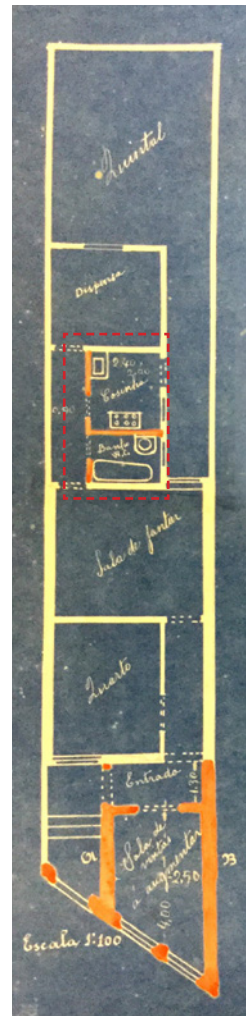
e 3.25 Plantas com banheiros tipo “B” e “C” em bairros em processo de consolidação da infraestrutura.
